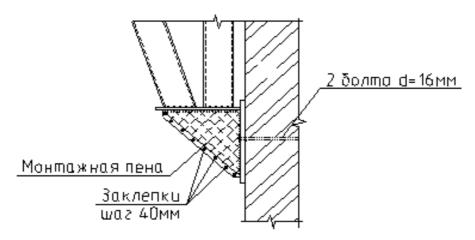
Утепление узла опирания столика, закрепленного в фундаментном блоке или кирпичной стене
